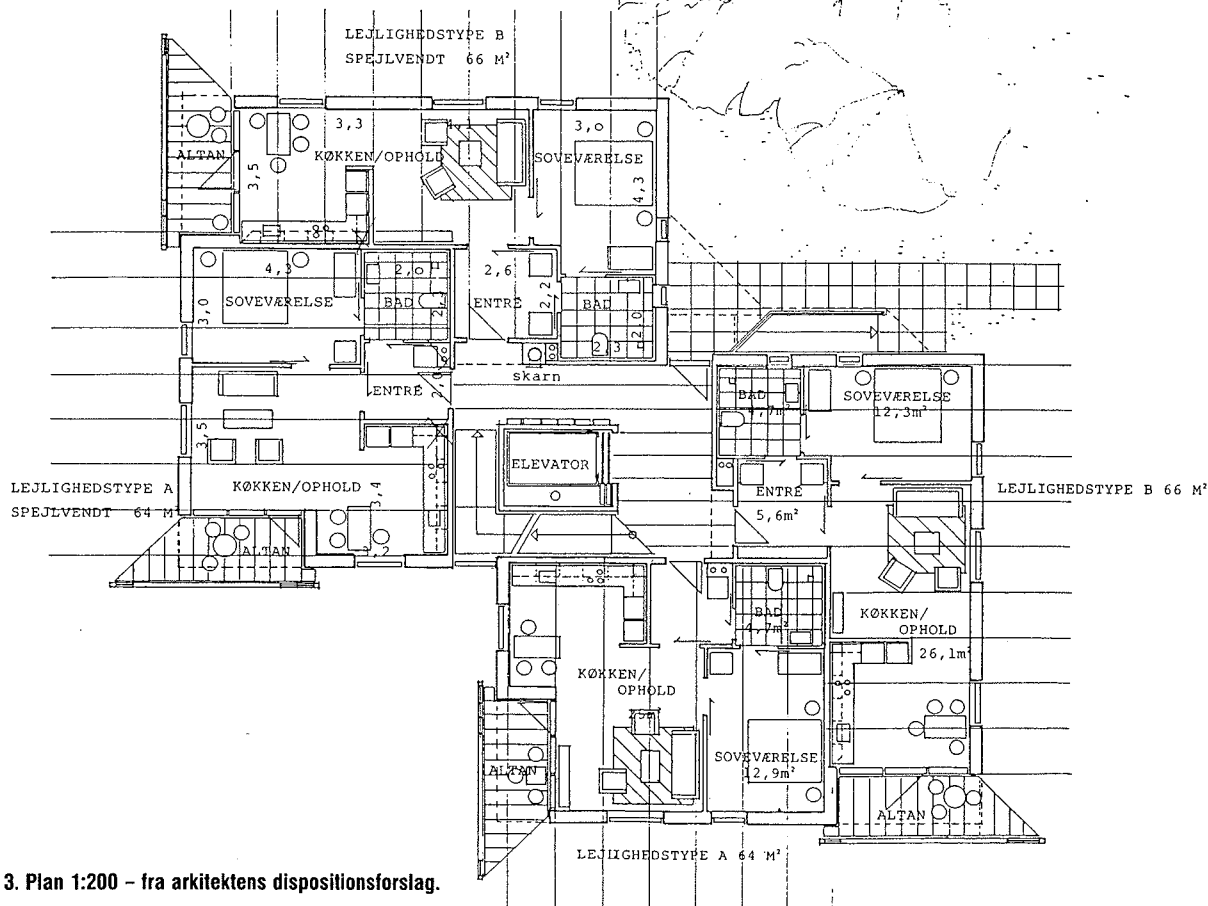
Plan 1:200 - fra arkitektens dispositionsforslag.
